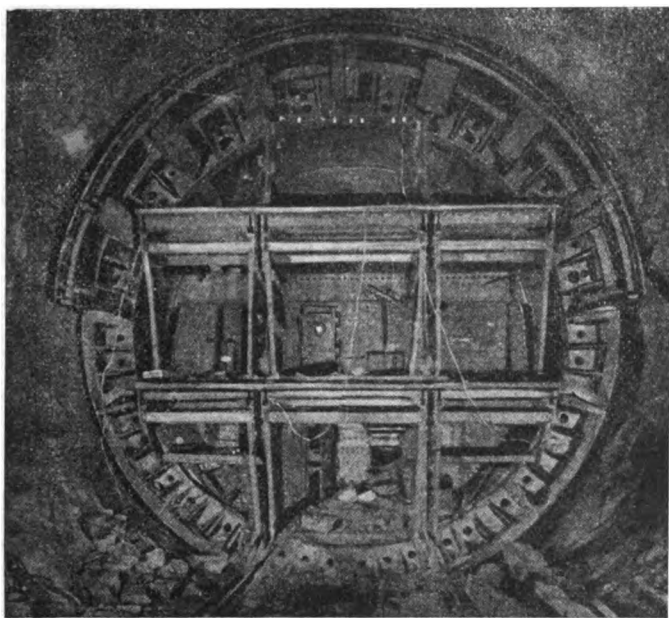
I tunnels sottomarini di New-York. - Vista di un tunnel in costruzione.
